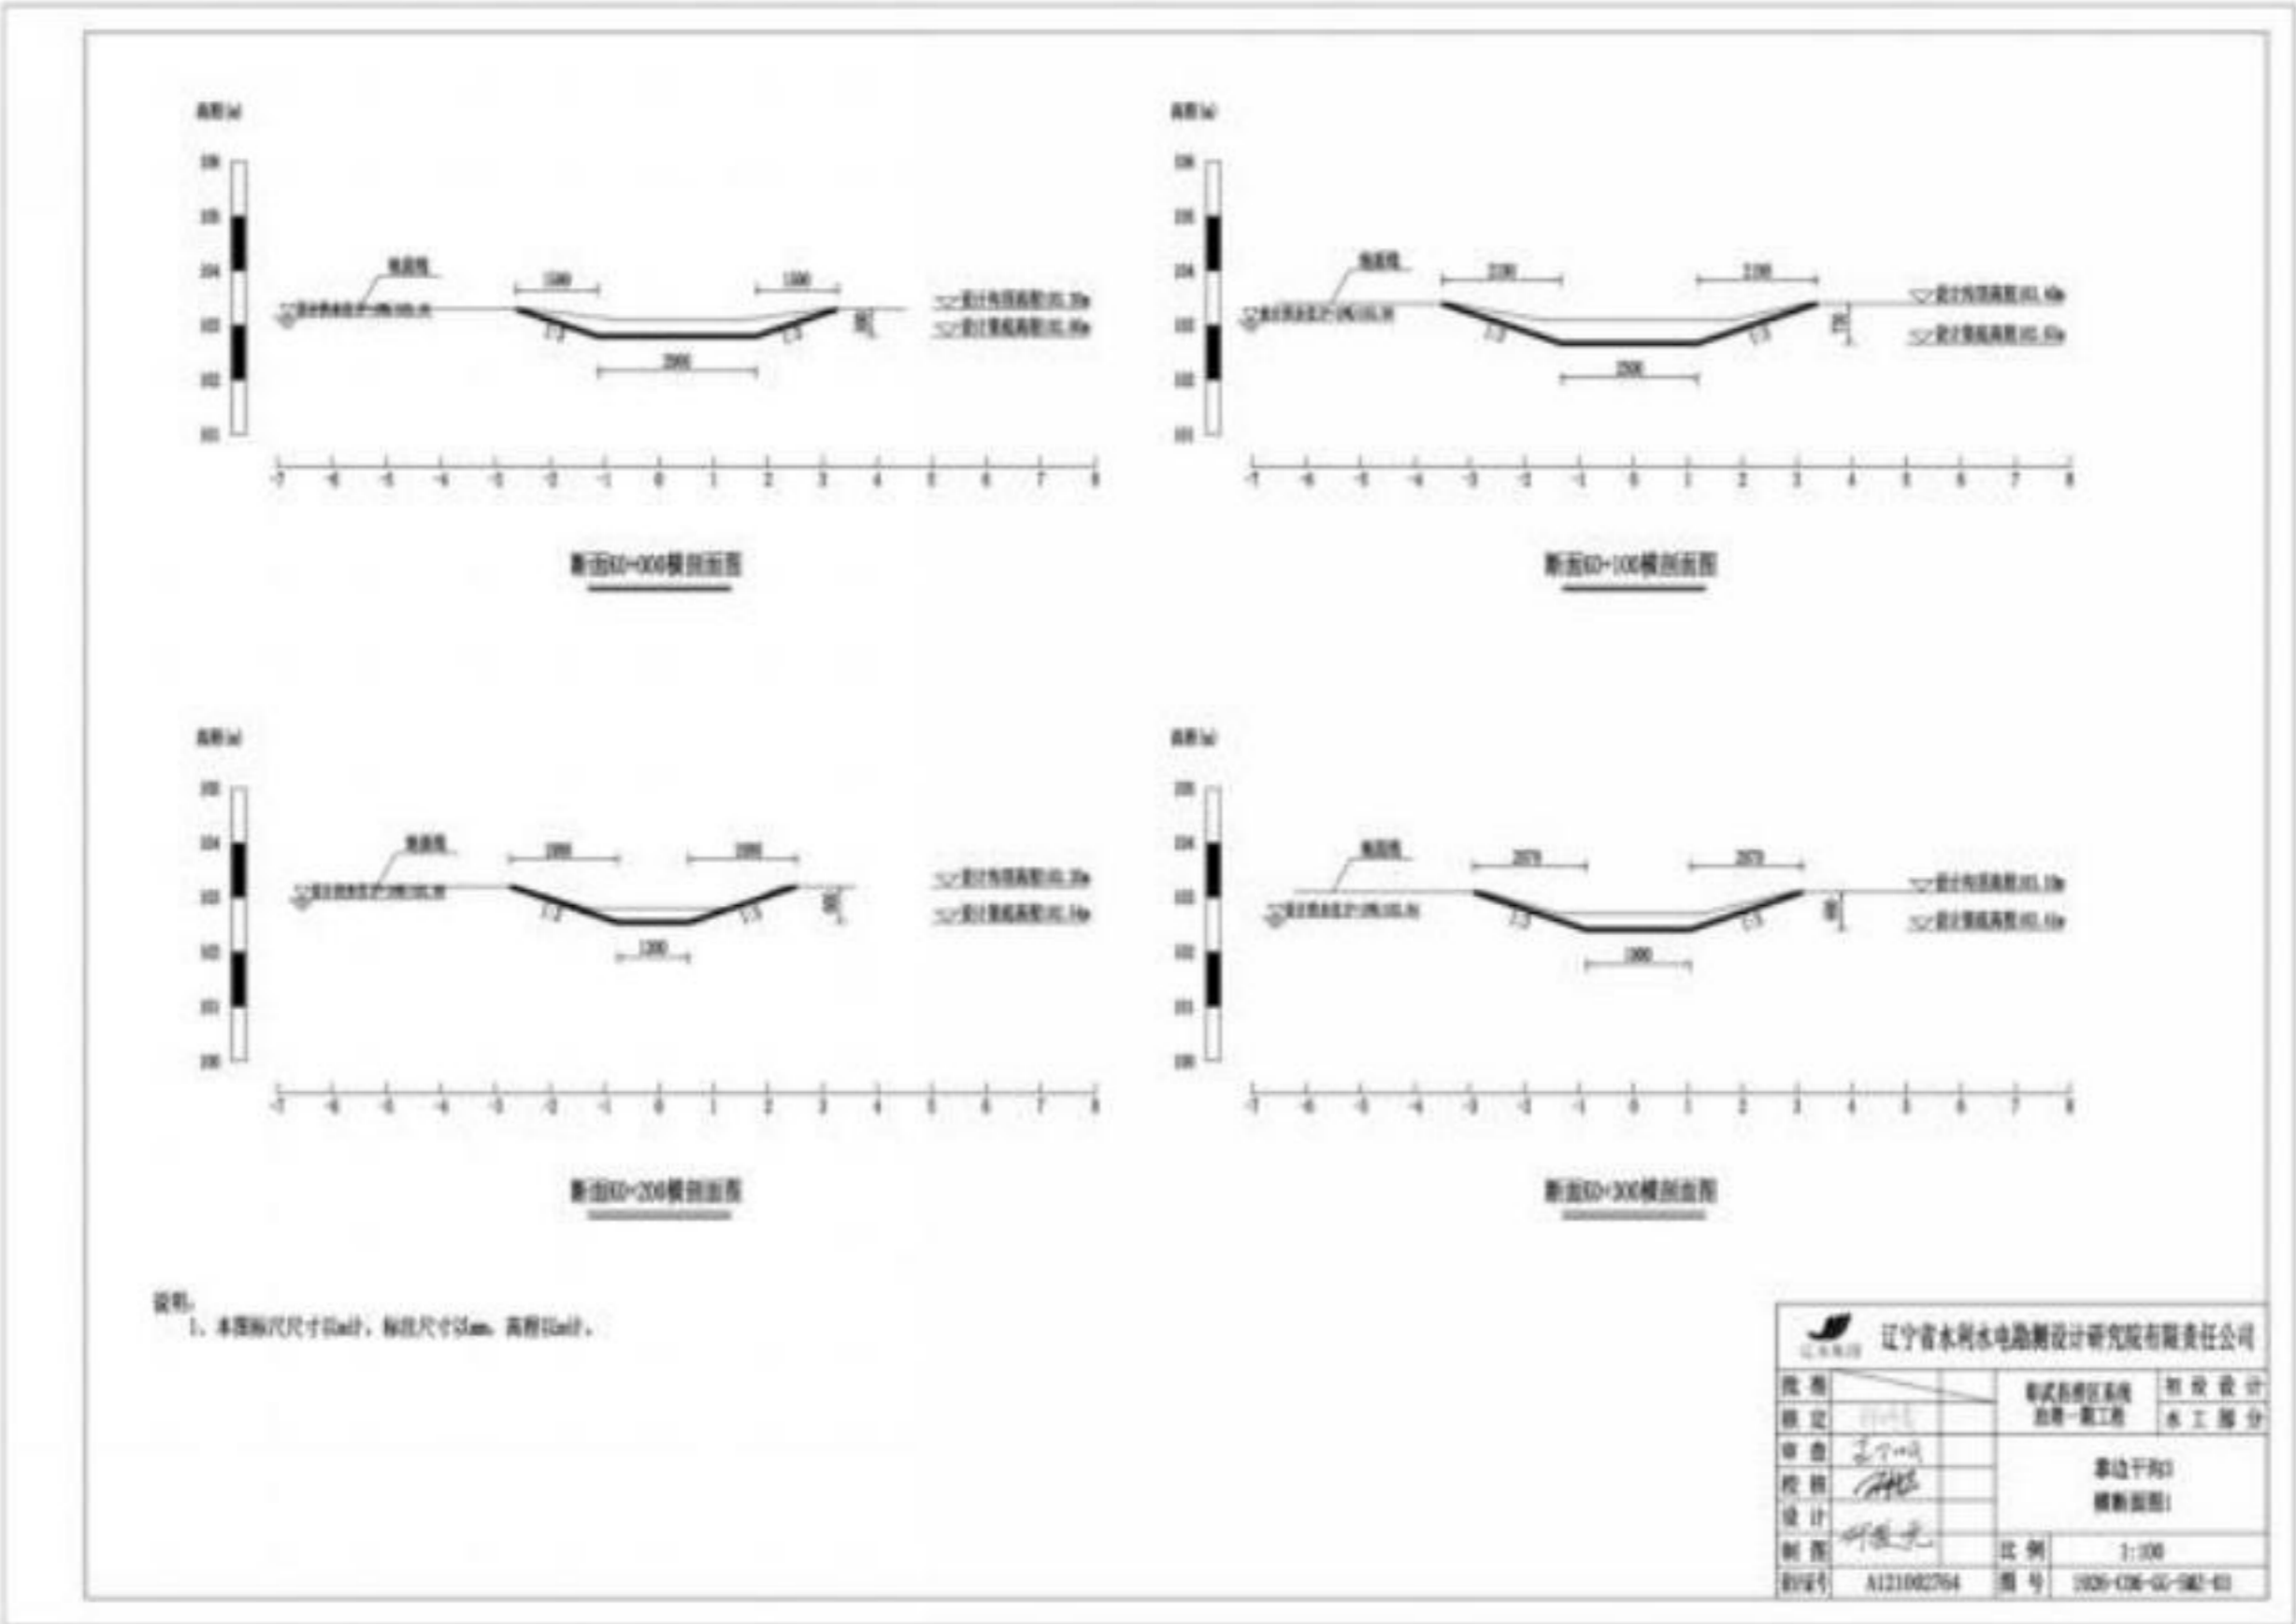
(1) 双庙镇靠边干沟 3 剖面图
